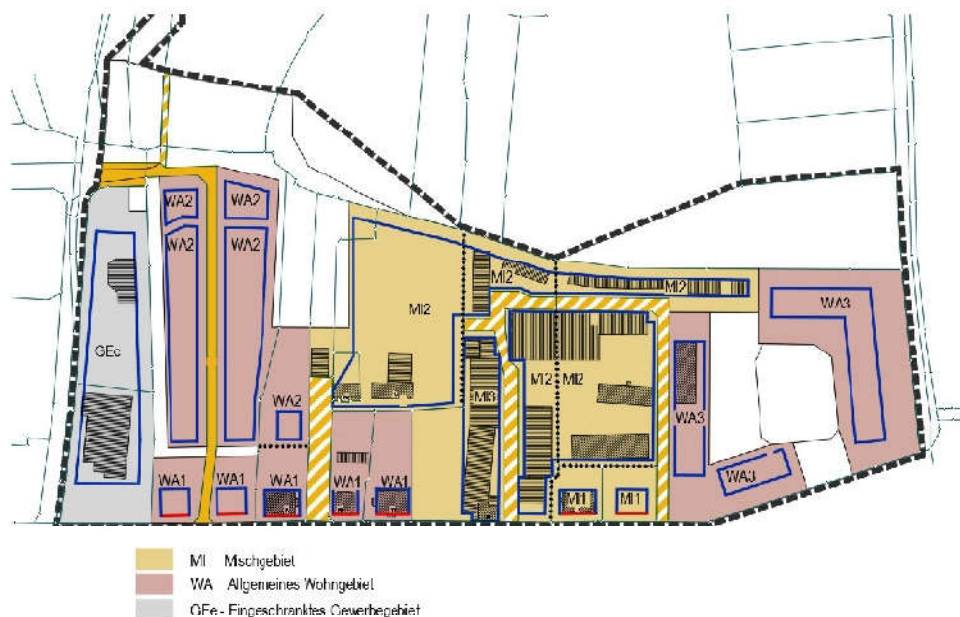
Übersichtslageplan Wohnbauflächen, Nutzungsart mit Nummerierung
